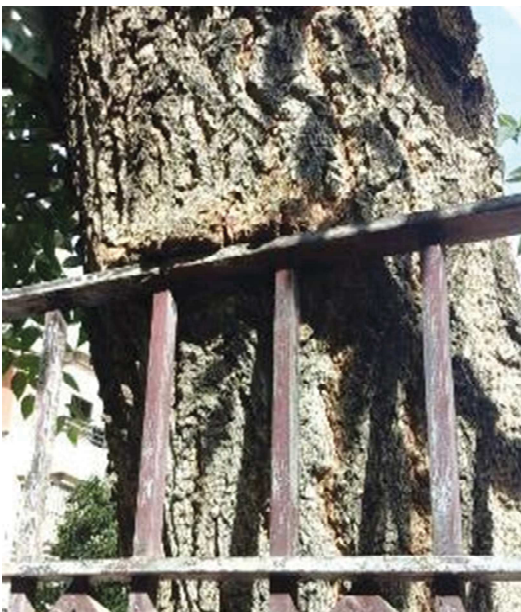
Afectación a vallado por crecimiento secundario y pavimento por desarrollo radicular
